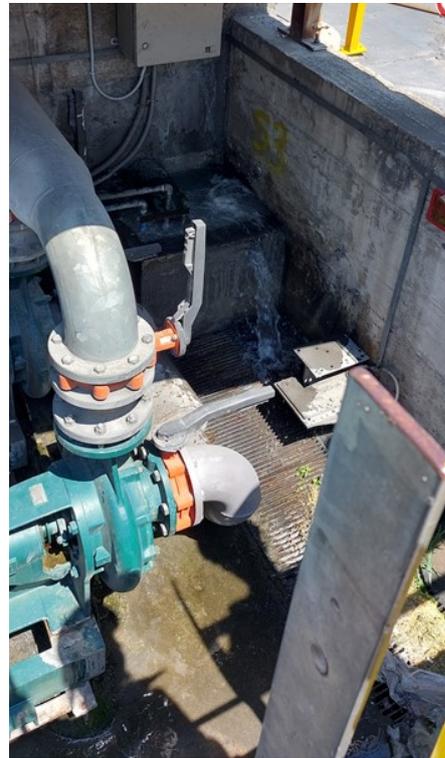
PARTICOLARE DELLA TRACCIMAZIONE DAL POZZETTO
